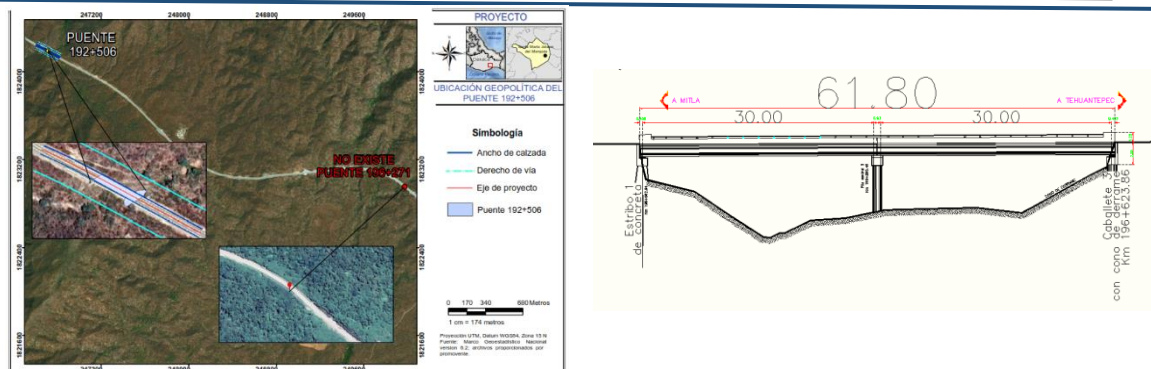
Proyecto en planta y perfil longitudinal del Puente 192+506.
